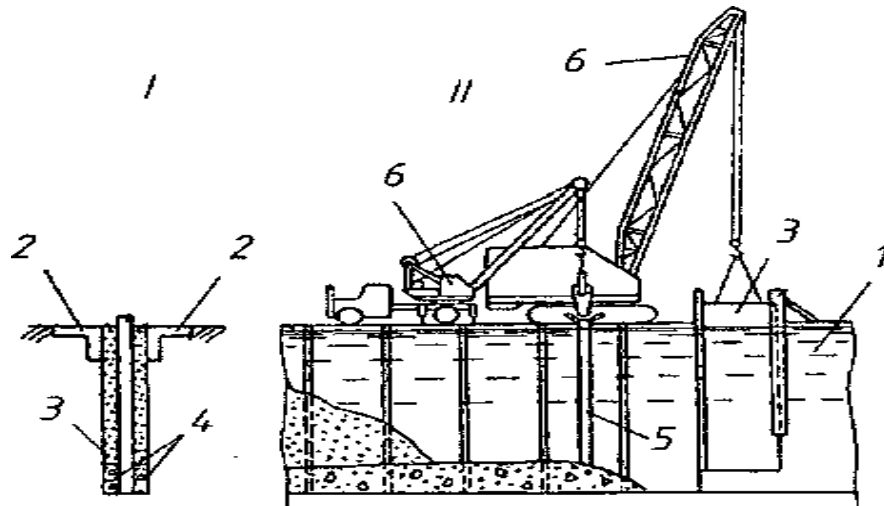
Схема влаштування конструкції «стіна в ґрунті» зі збірних залізобетонних панелей: I - поперечний переріз траншеї після занурення стінової панелі; II - поздовжній розріз траншеї в процесі виконання робіт;
